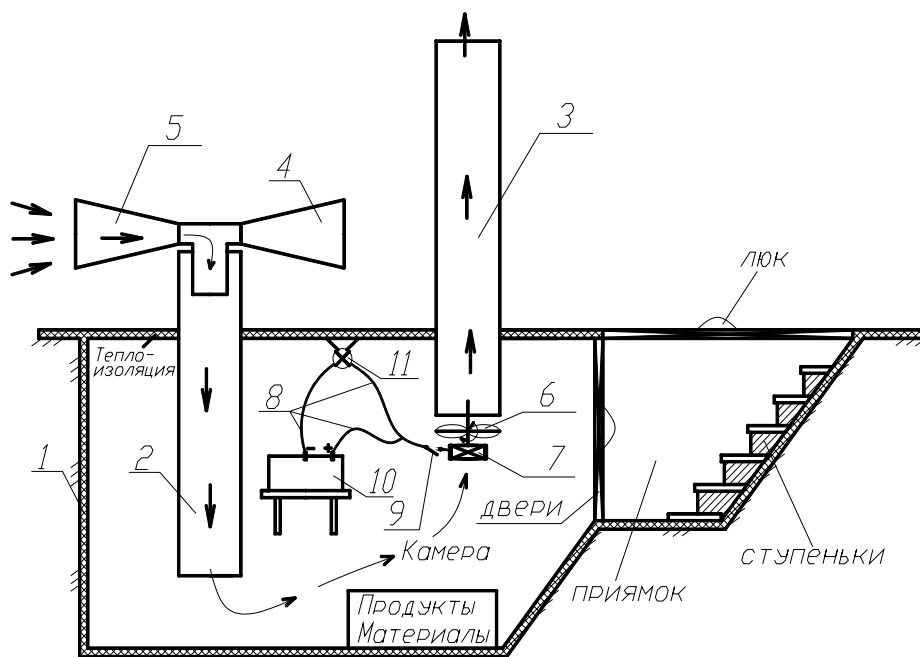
Холодильная камера в грунте без освещения (патент РБ №5073):
